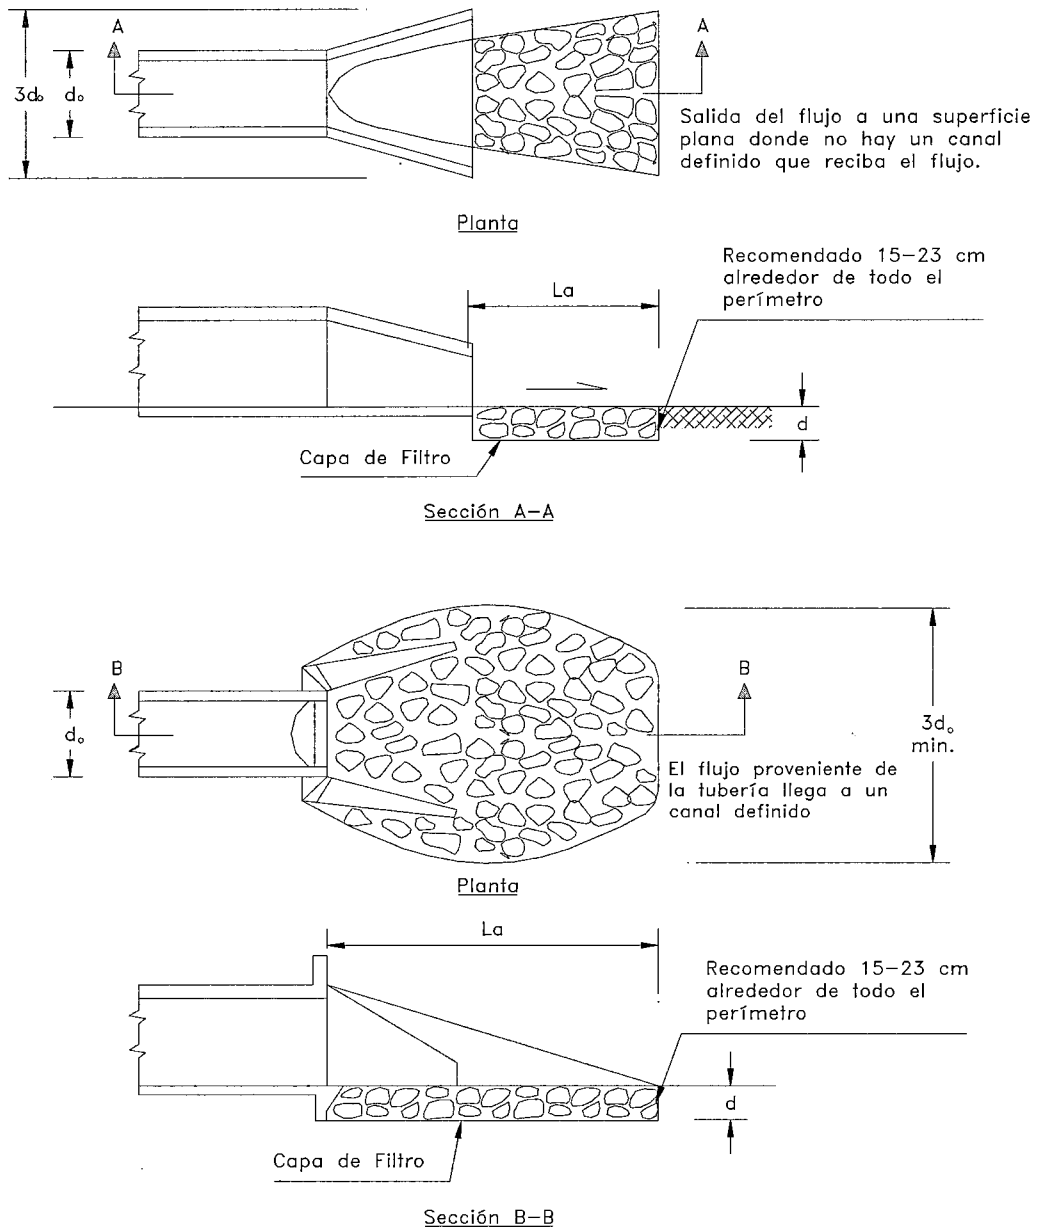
Aliviadero en la Salida de la Alcantarilla Circular.
